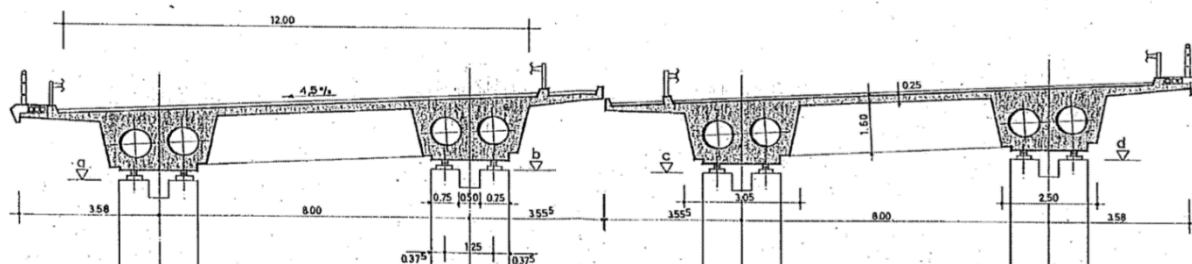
Desenho de projeto da estrutura do tabuleiro em laje nervurada (corte transversal)
